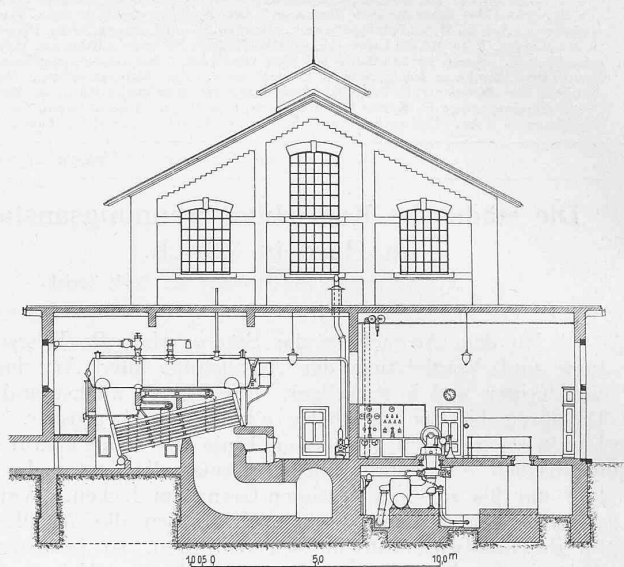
Längenschnitt durch das Kessel- und Maschinenhaus. — 1:300.
